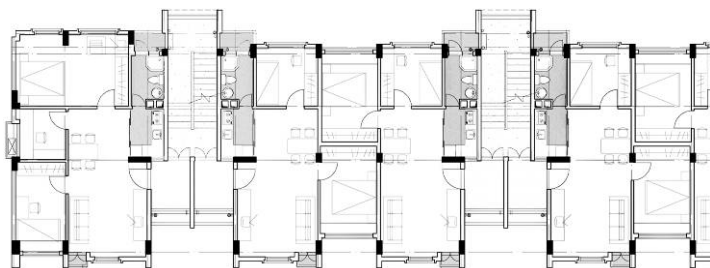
住宅户型平面图 (来源: 设计文件)
